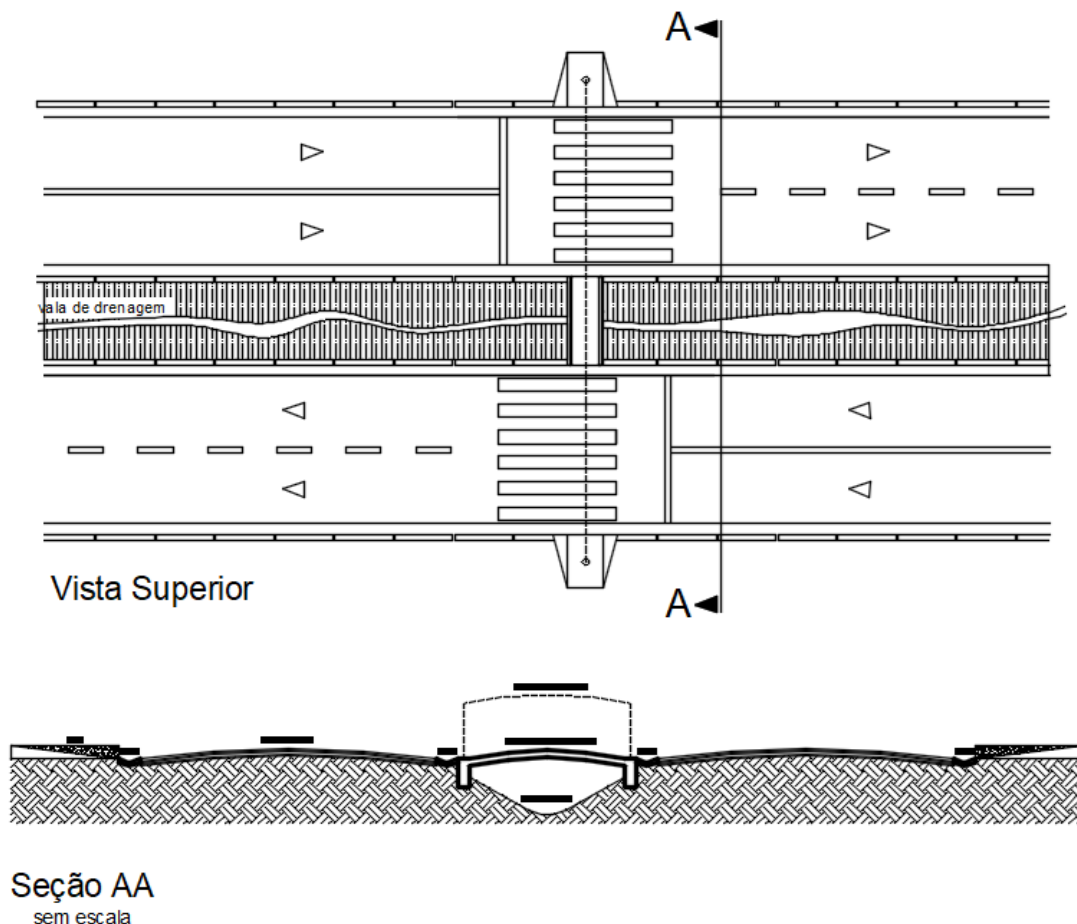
Exemplo sem escala, medidas em metros. Canteiro central em desnível.
